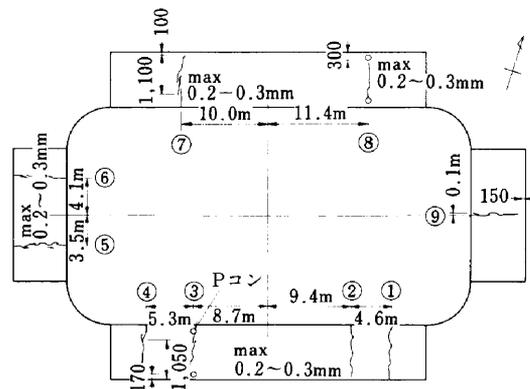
2Pコンクリートひび割れ発生状況図 (第4リフト側面)
